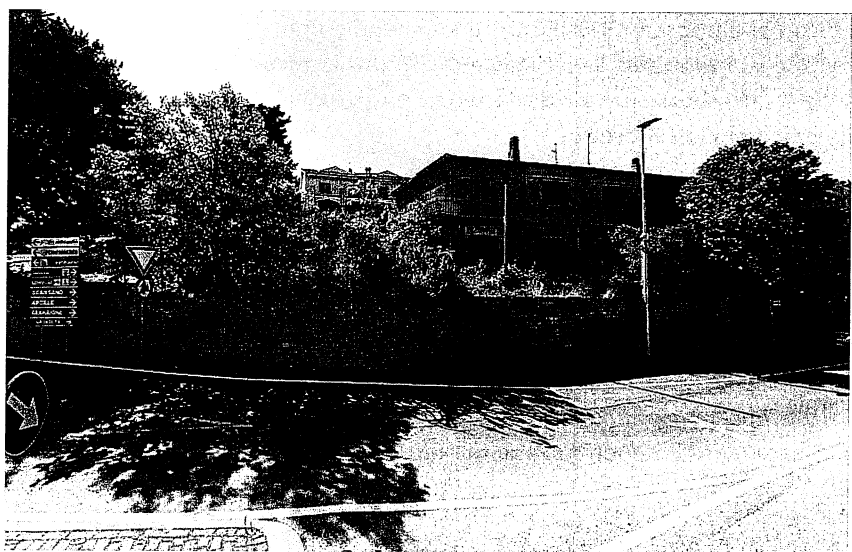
Vista d'insieme del fabbricato dalla Strada Provinciale 18
